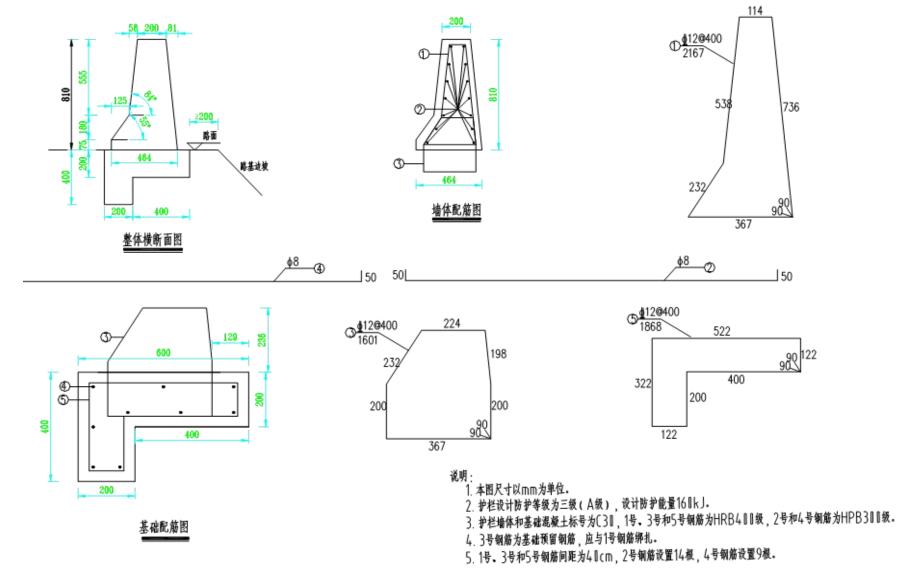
三 (A) 级 F 型路基混凝土护栏设计示例 (尺寸单位: mm)
